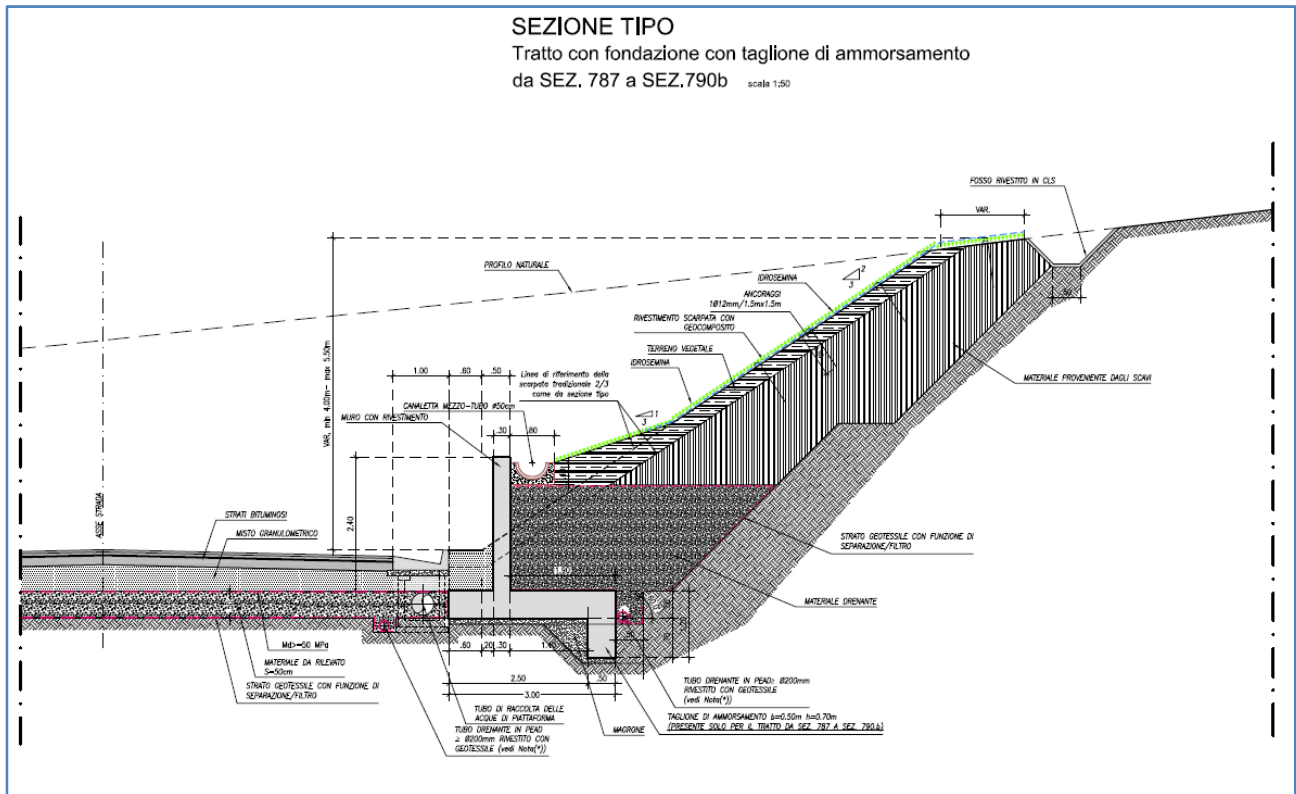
Sezione tipo muro di sostegno OS99 con la sezione di scavo revisionata
